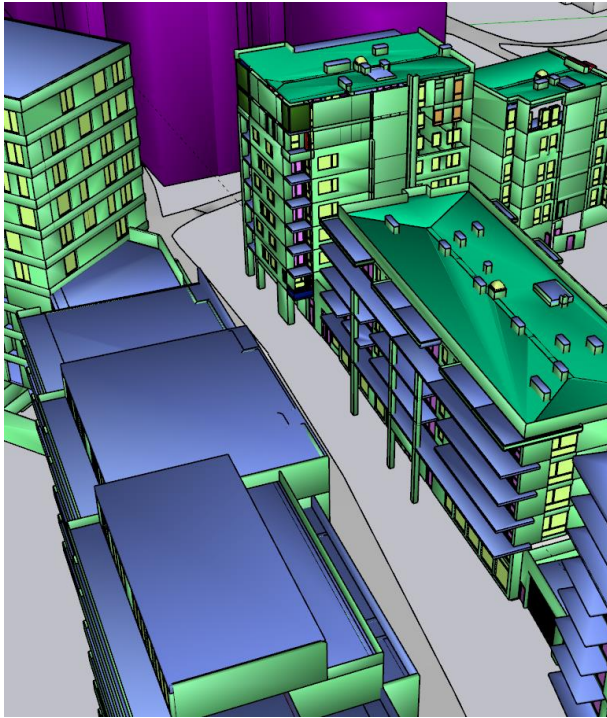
Forretningsarealer i plan 1 i Varden (høyre) og Høyden (venstre).
